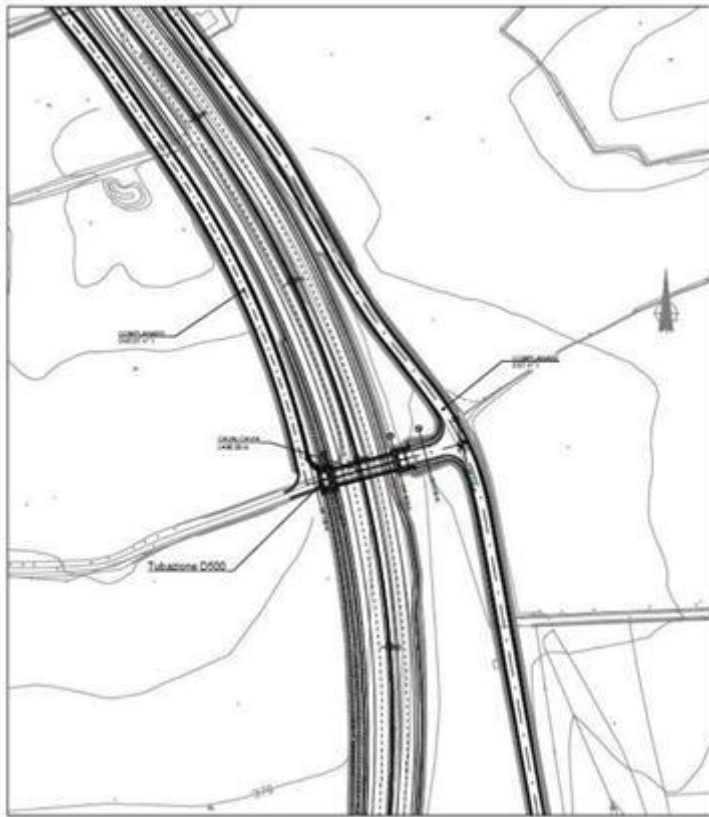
Planimetria Cavalcavia al km 1+800
